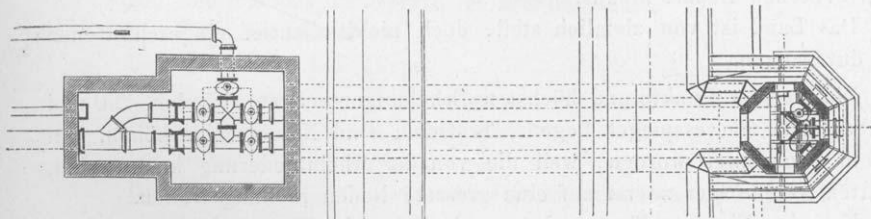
Staumauer von Chemnitz. Grundriss.
